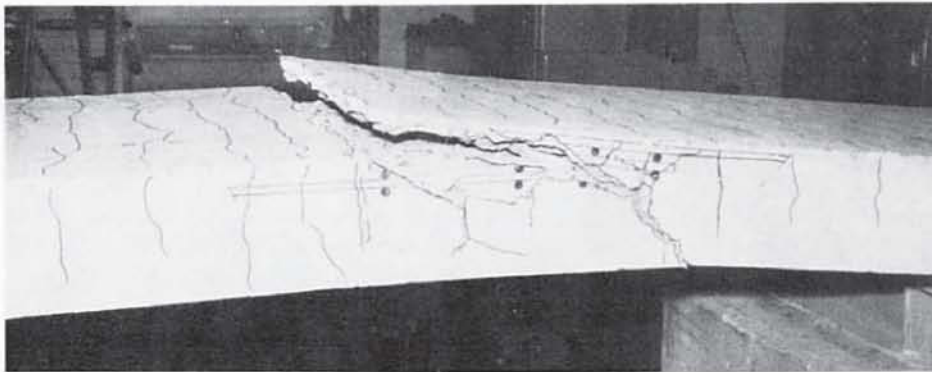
Bruch eines Übergreifungsstoßes geschweißter Betonstahlmatten (entnommen aus [4])
